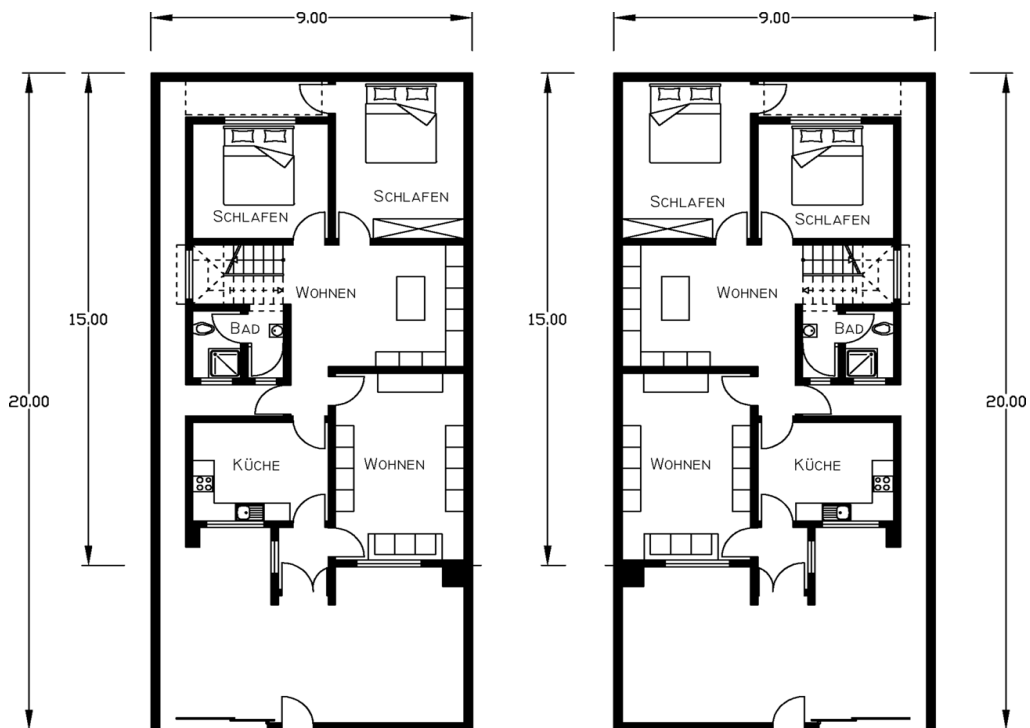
Grundriss Typ B Eckhaus¹⁹⁹
